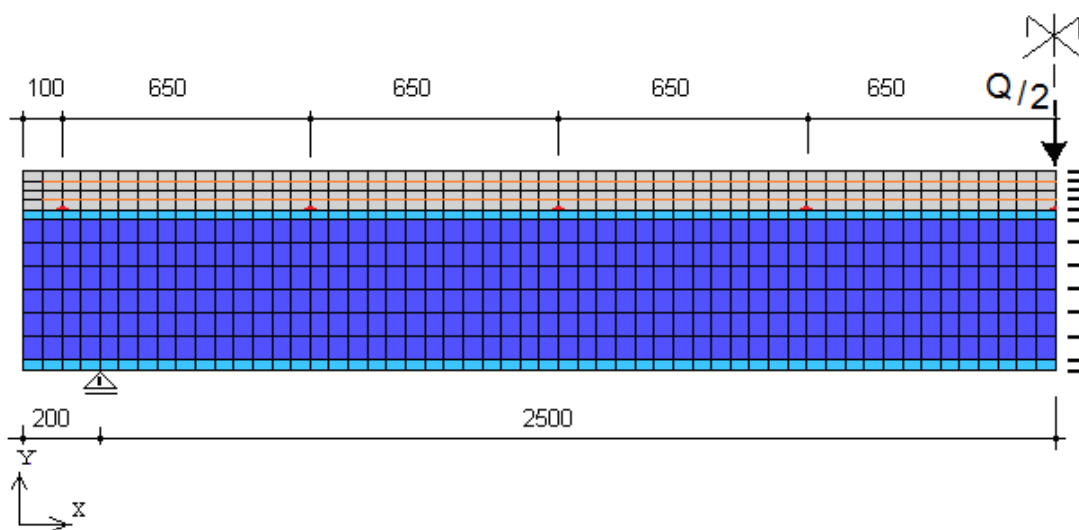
Poutre mixte simplement appuyée ( P14 )
